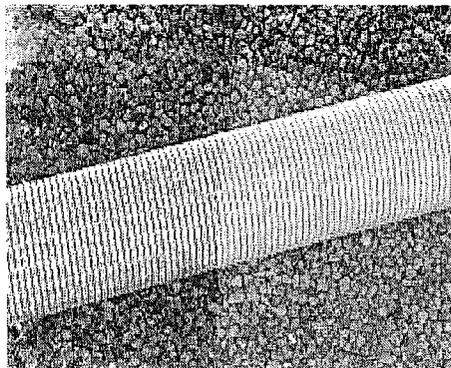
Vista general ranuras (filtros) de tubo PVC RDE 21 de 10”.
